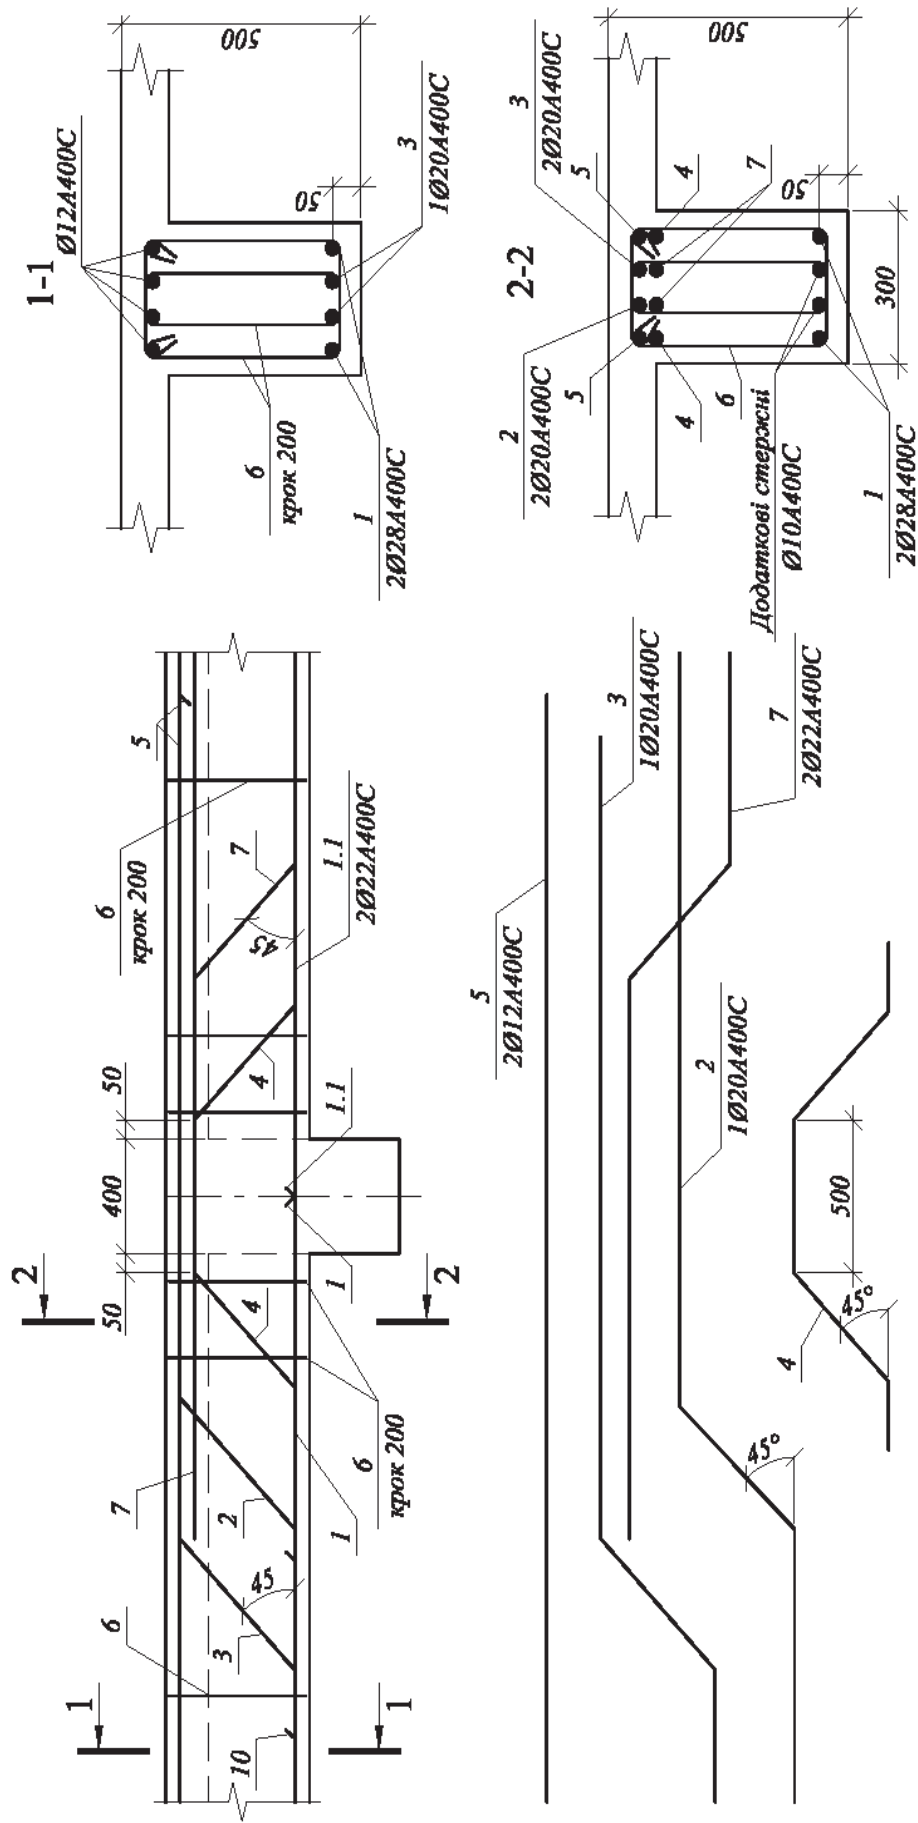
Приклад армування проміжної опори другорядної балки поперечною вертикальною і відігнутою (похилою) арматурою: поз.1 та 8 – прольотна арматура, що не відгинається; поз.2 та 3 – прольотні стержні, які відгинаються з лівого прольоту на опору
